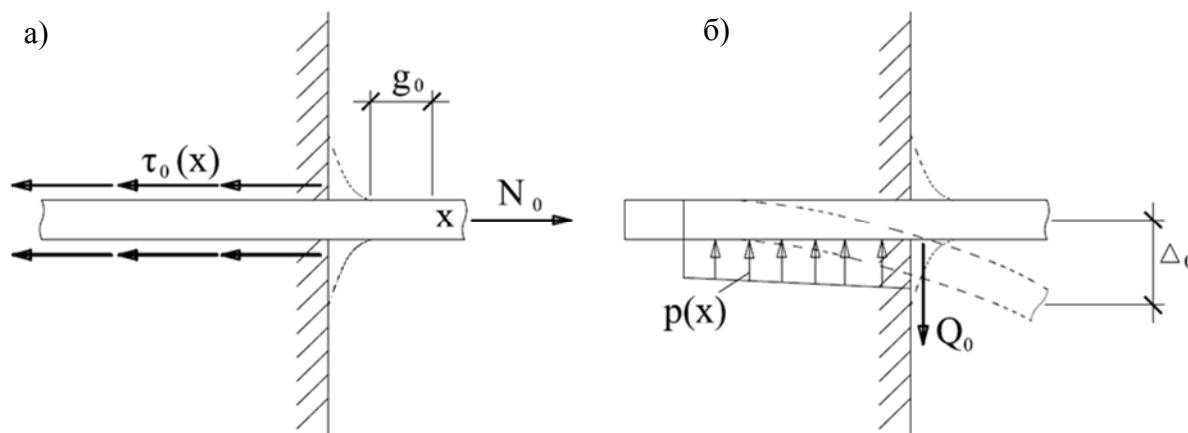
Работа стержневой арматуры при экспериментальном приложении нагрузки: а) продольное нагружение; б) поперечное нагружение
